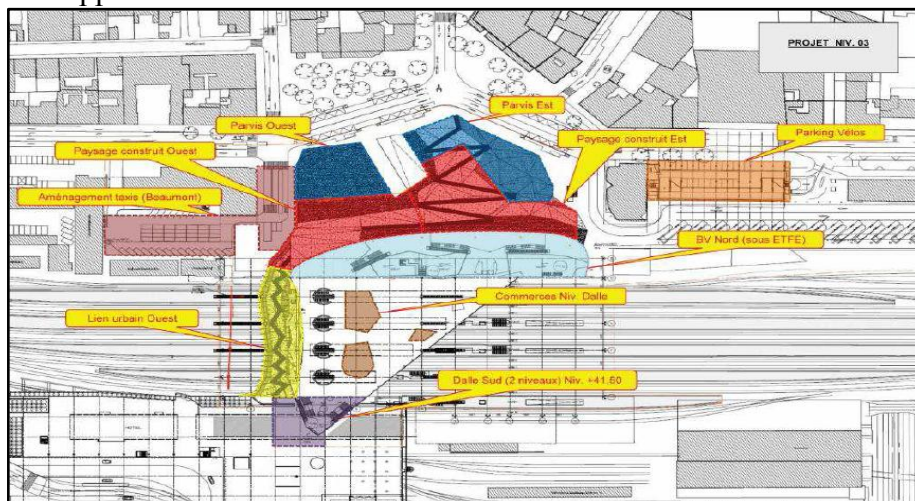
Plan de niveau 3 de la toiture de la gare PEM³⁹
